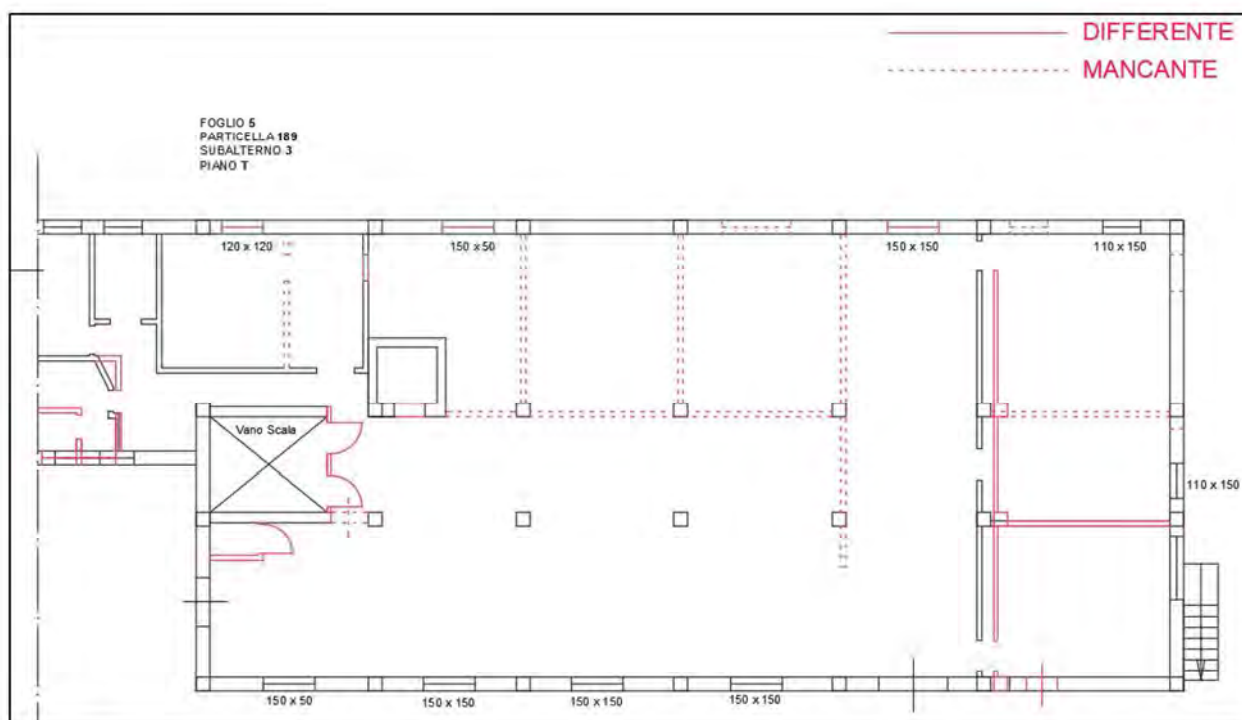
Planimetria piano terra - Difformità tra progetto in variante e stato di fatto rilevato durante il sopralluogo del 07.02.2019
